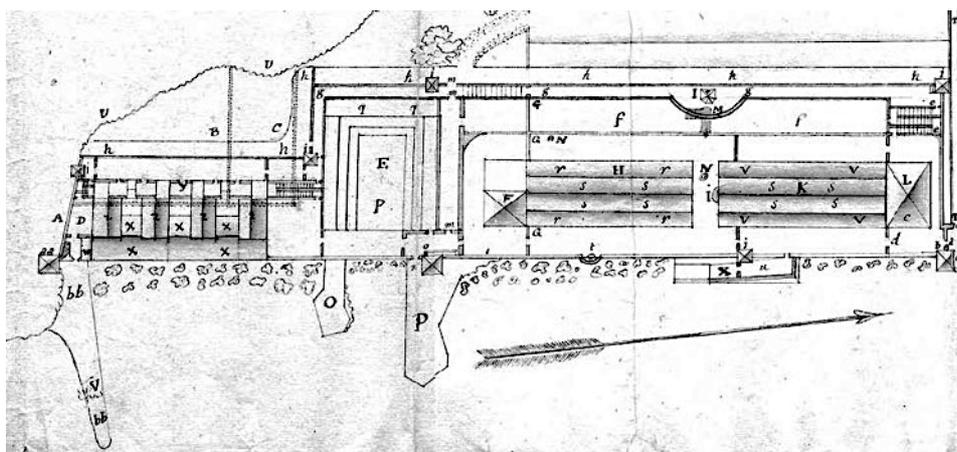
Plan du secteur après sa transformation en arsenal (réalisée vers 1776) pour la construction de frégates ; on y reconnaît encore sur la droite (au nord) la trace des deux bâtiments primitifs ainsi que la « forme » de construction des frégates (E et P) prolongée sur la côte par deux môles (O et P) ; au sud, divers ateliers et le magasin à bois (x).
